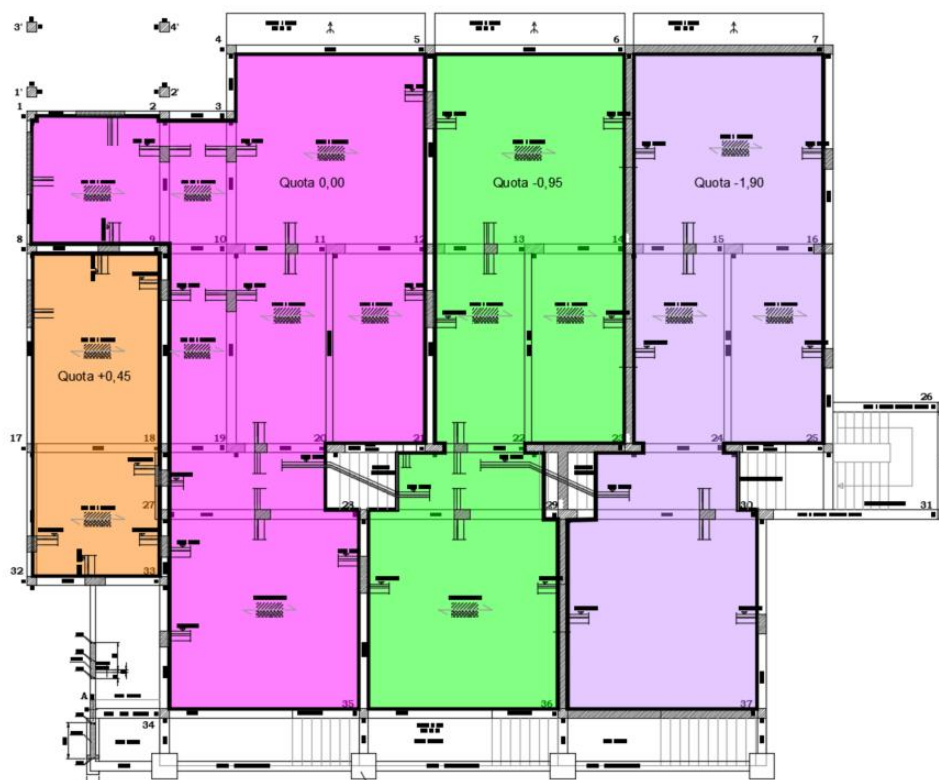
Pianta piano terra (progetto strutturale – 1975) con evidenziati i diversi livelli di quote
